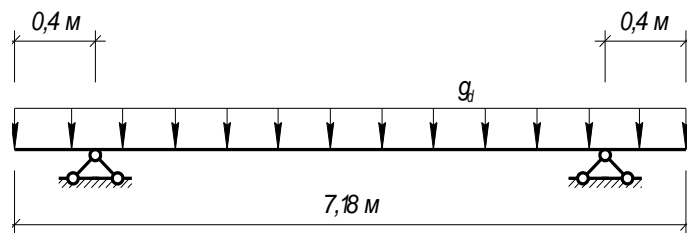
Розрахункова схема плити перекриття в стадії виготовлення та монтажу
